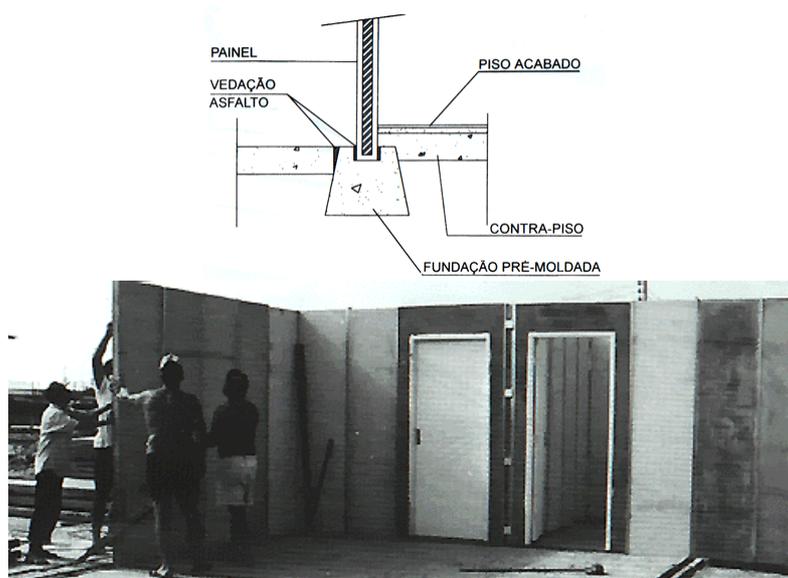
Fundações e montagem dos painéis do sistema Comodi
